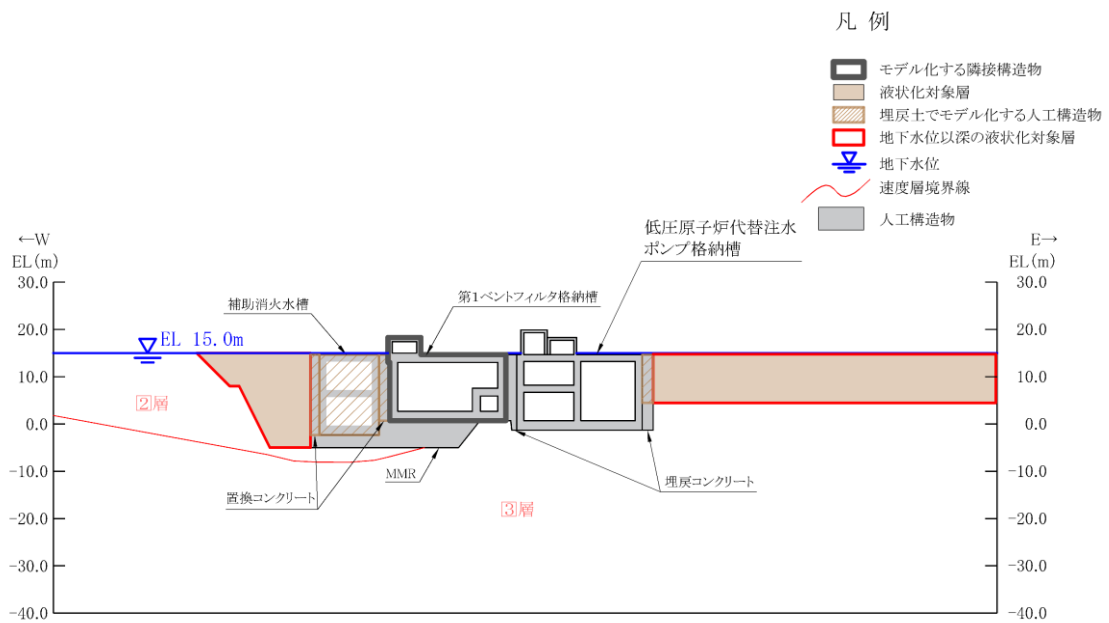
低圧原子炉代替注水ポンプ格納槽 断面図 (C-C 断面位置)
